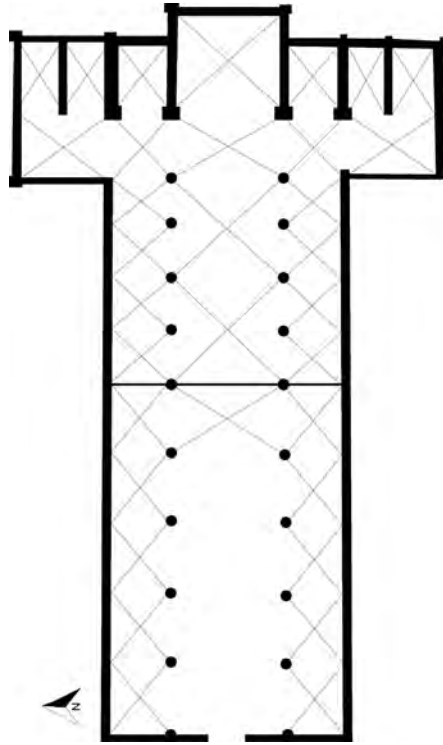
Milano, San Marco. Pianta del progetto originario secondo la ricostruzione proposta (elaborazione grafica dell'autrice).
